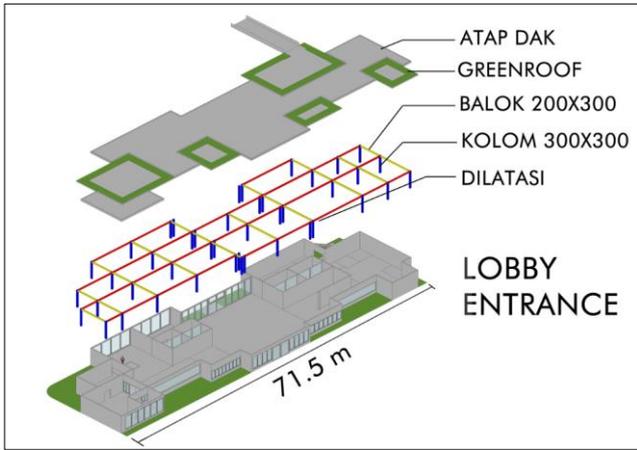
Sistem struktur rangka konstruksi beton. Bangunan utama.
